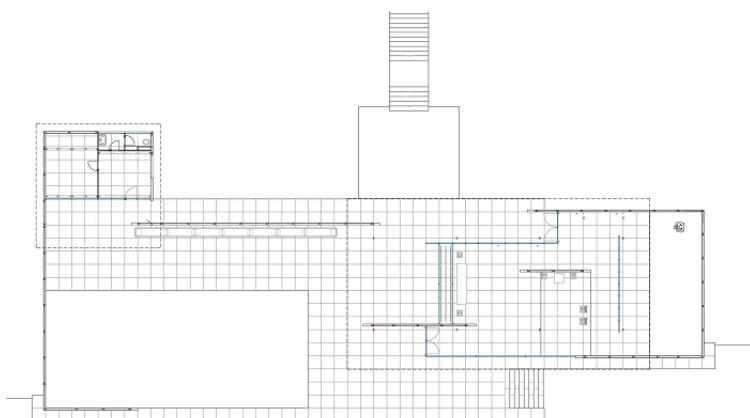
Pabellón de Barcelona. Esquema planta baja y planta superior (1928-1929).
